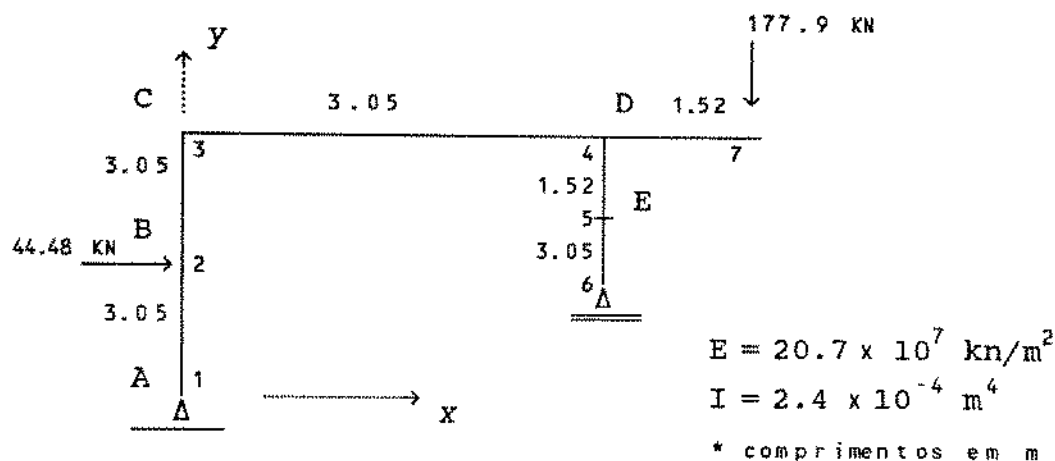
PÓRTICO PLANO COM CARGAS CONCENTRADAS
